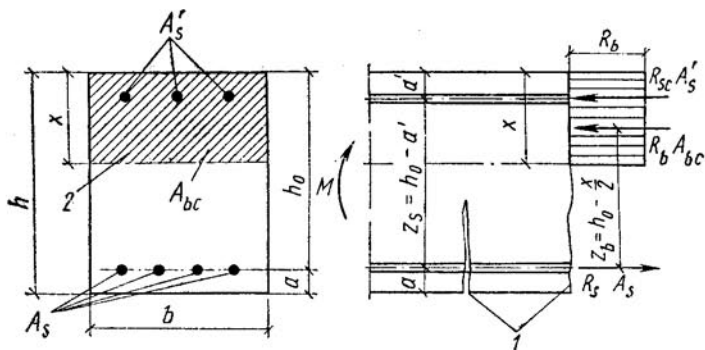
Прямоугольное сечение с двойной арматурой и схема усилий при расчете прочности элемента по нормальному сечению
